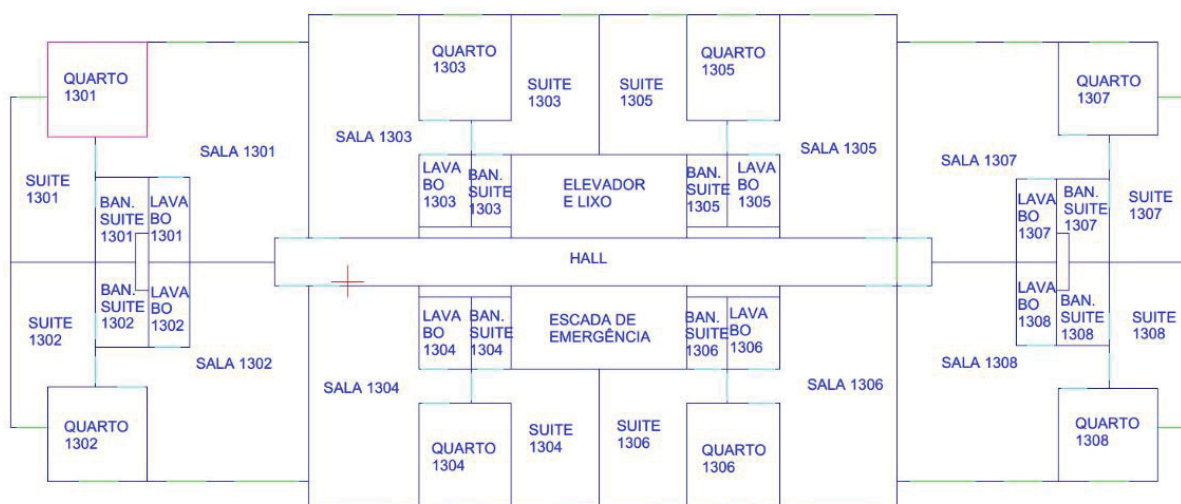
Planta Baixa do pavimento TIPO 1, pavimentos 3 a 13
